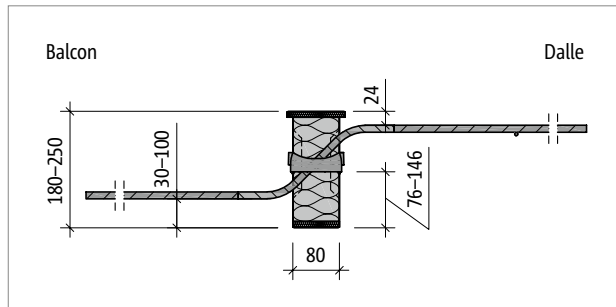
Schöck Isokorb® T type Q-E-V6 : coupe du produit
